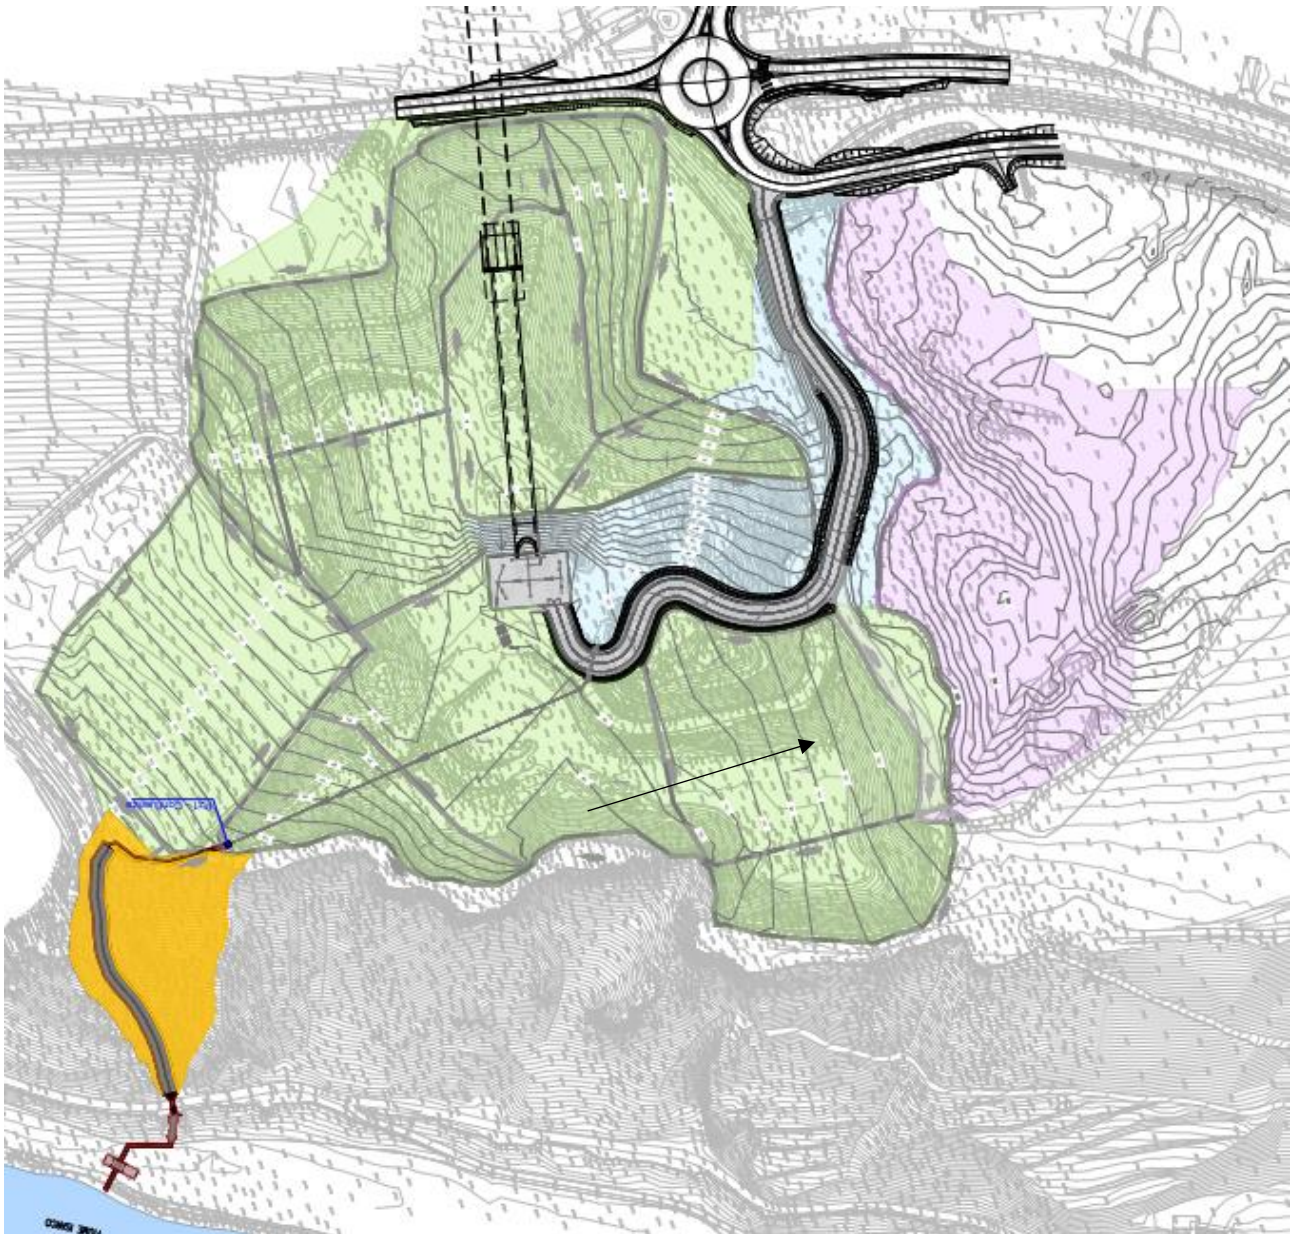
Planimetria idraulica Deposito Forch con recapito nell'Isarco (PE)
